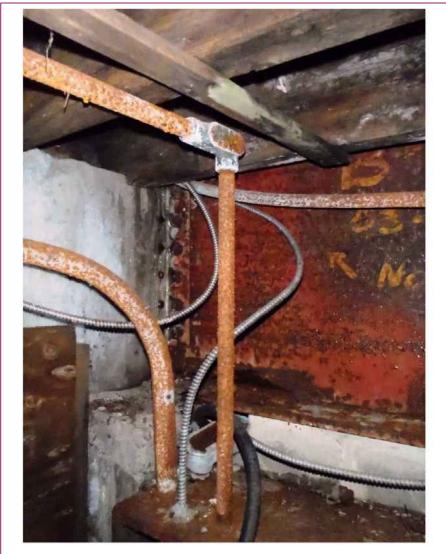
Poutre maîtresse à son appui sur un massif interne corrodé au niveau de ses assemblages
